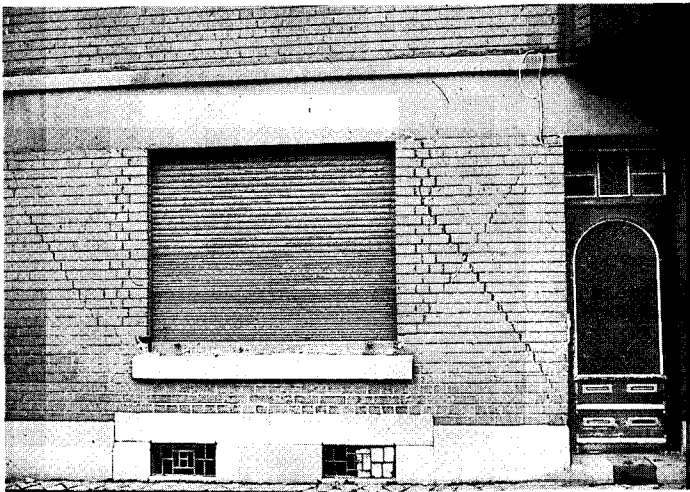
Fissures de cisaillement affectant une façade.
